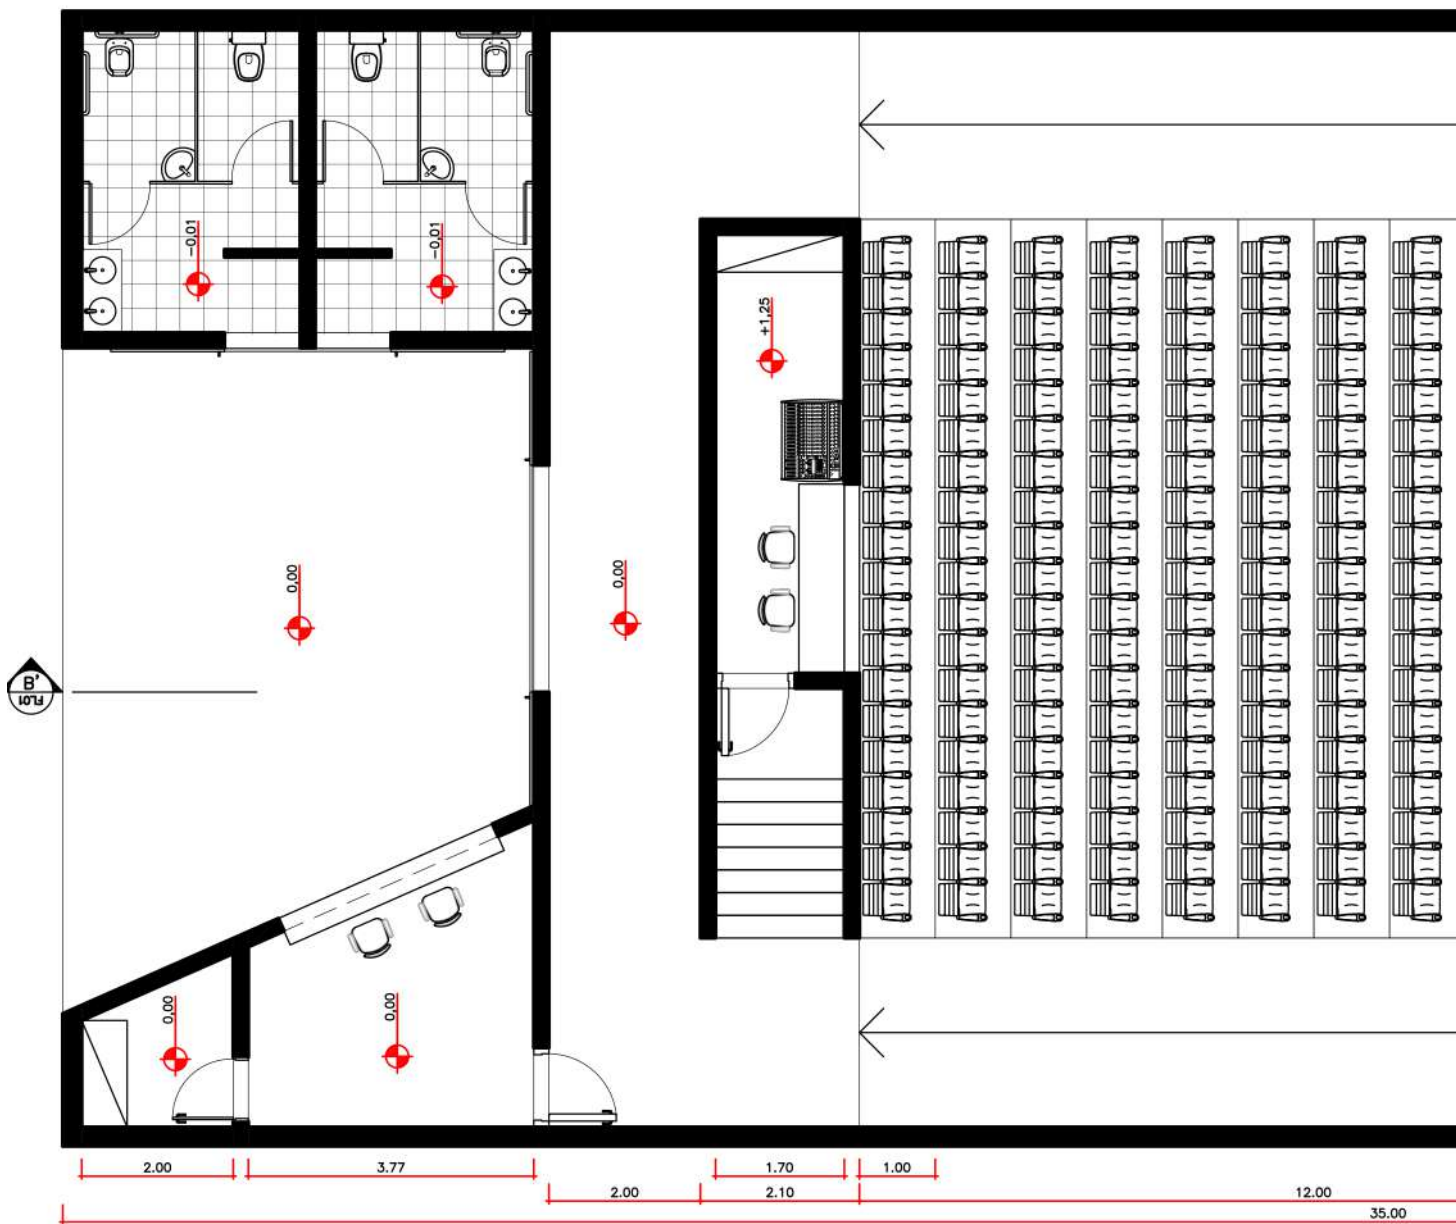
PLANTA DO BLOCO DO AUDITÓRIO - ESC.: 1:200
